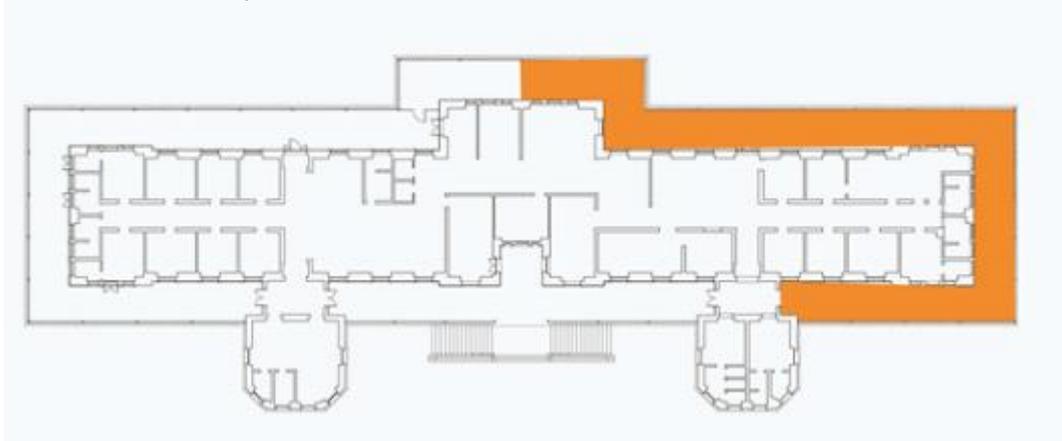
Planta baixa do Hospital Evandro Chagas – 1º pavimento - indicação da área analisada (desenho da autora)
